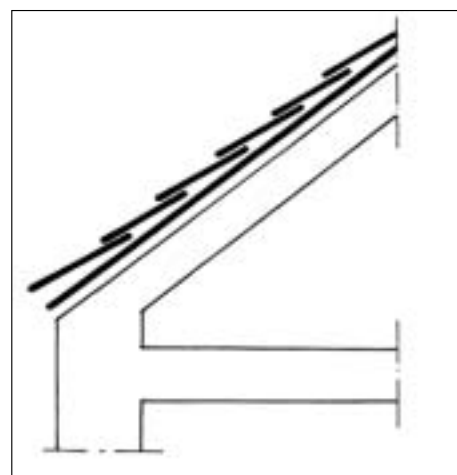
Nur im Zusammenwirken der Dacheindeckung mit einem wasserdichten Unterdach kann insgesamt von einer wasserdichten Dachkonstruktion ausgegangen werden.
